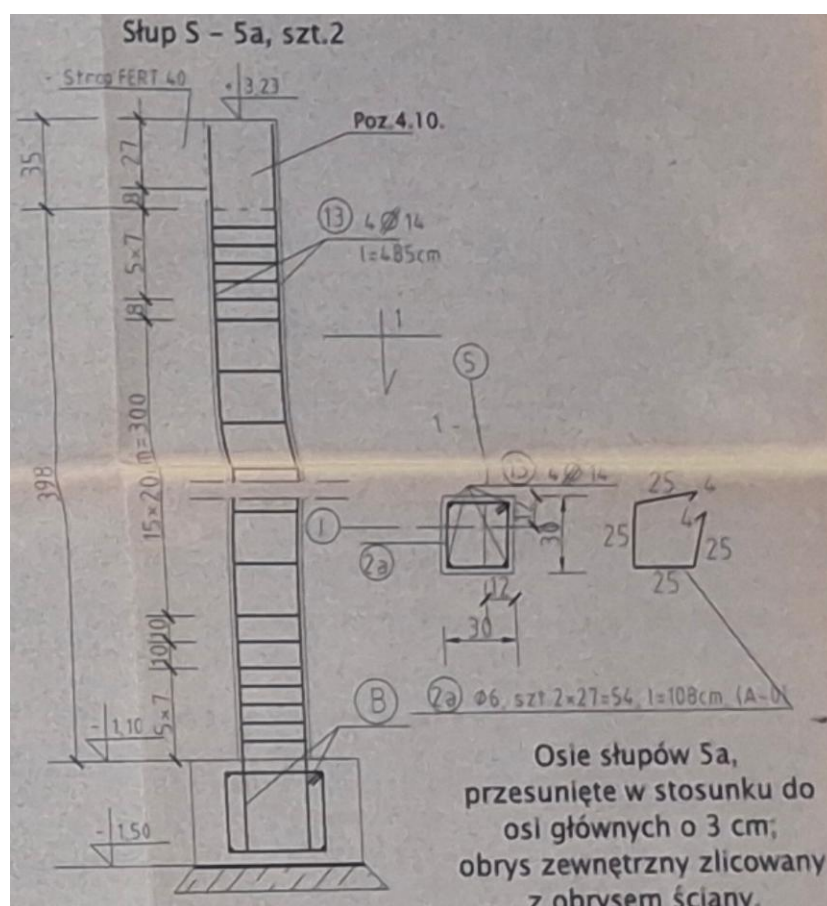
Słupy (trzpień) żelbetowe wg [2]
